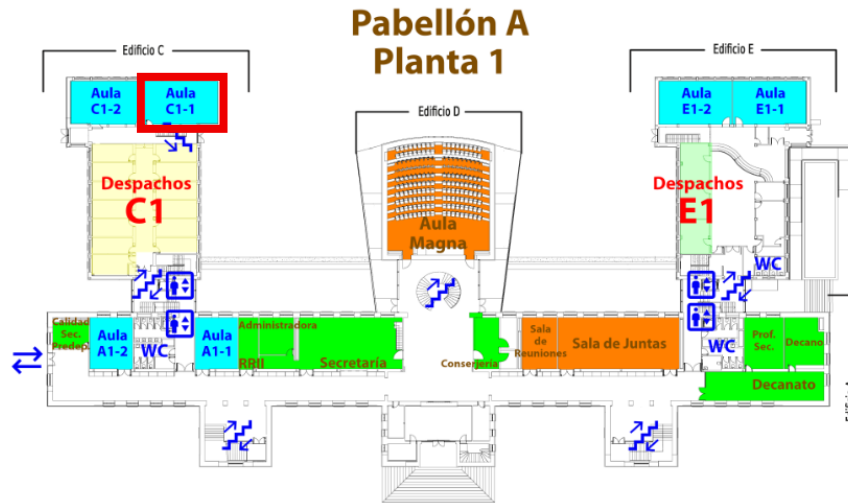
Planta 1 del Pabellón A. Fuente: Planos de la Facultad. <https://fyl.unizar.es/planos-de-la-facultad>
